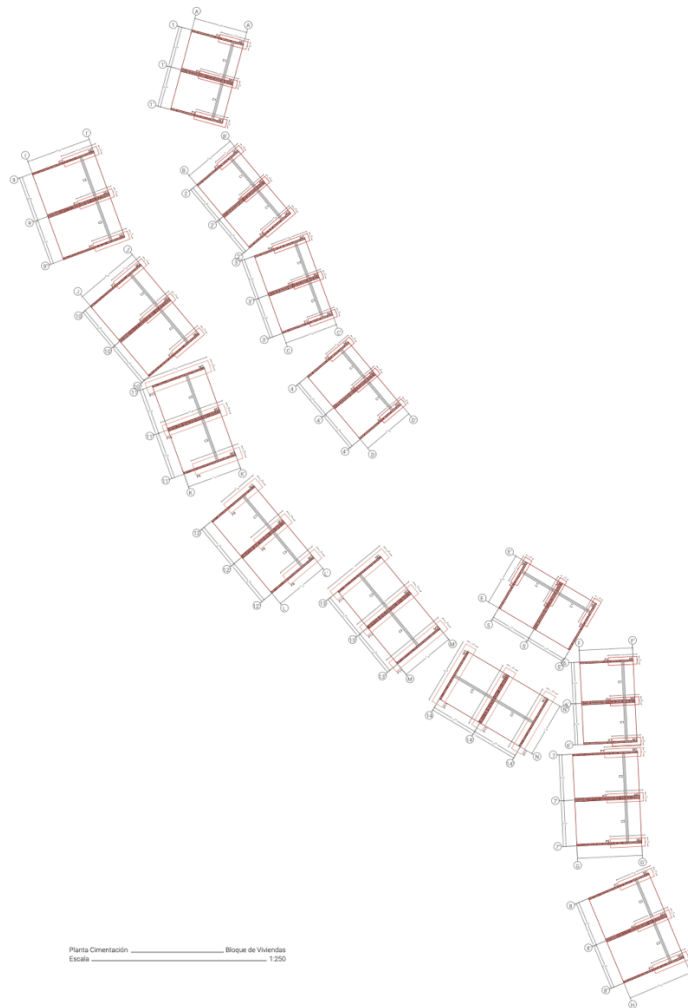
Planta cimentación volumen vivienda (Elaboración propia)
